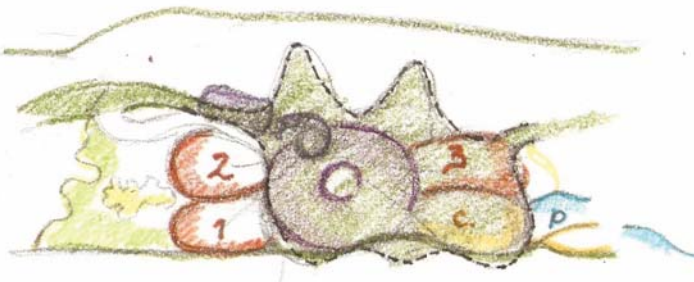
Finalmente la cubierta actuará a manera de terreno dando continuidad a los recorridos existentes.
